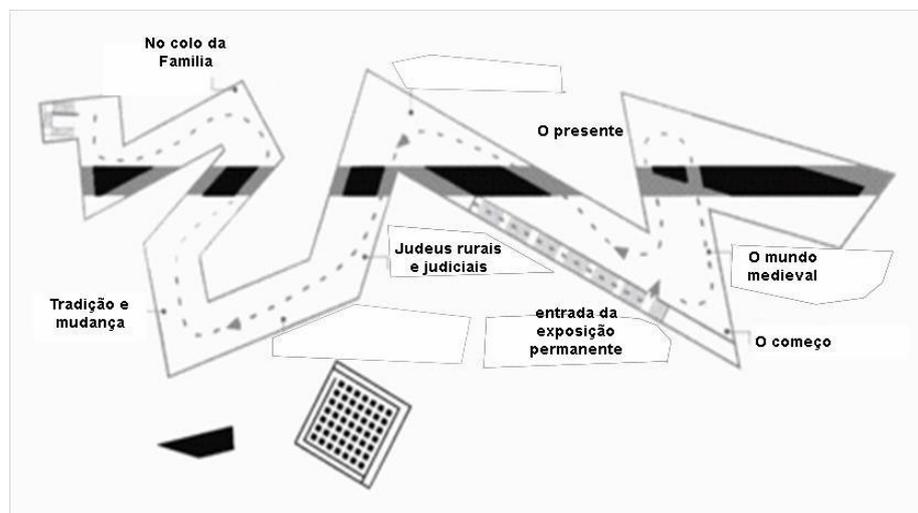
Esboço do primeiro pavimento, composto pelas exposições.
